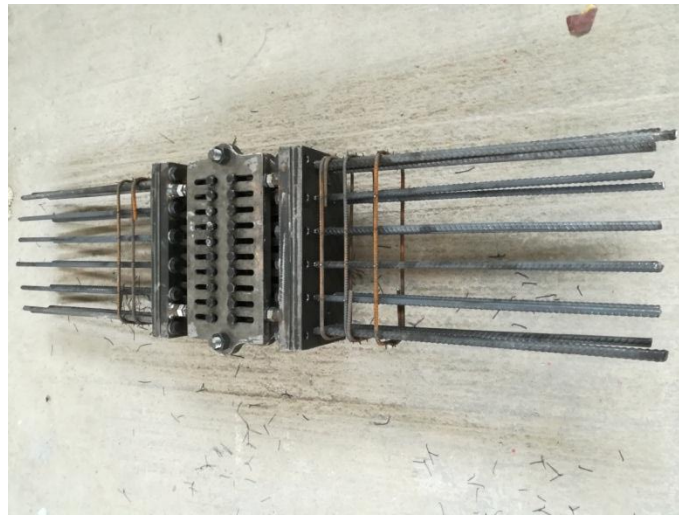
Tahterevalli tipi bağ kirişi deney elemanı (TETOD) donatı detayı
